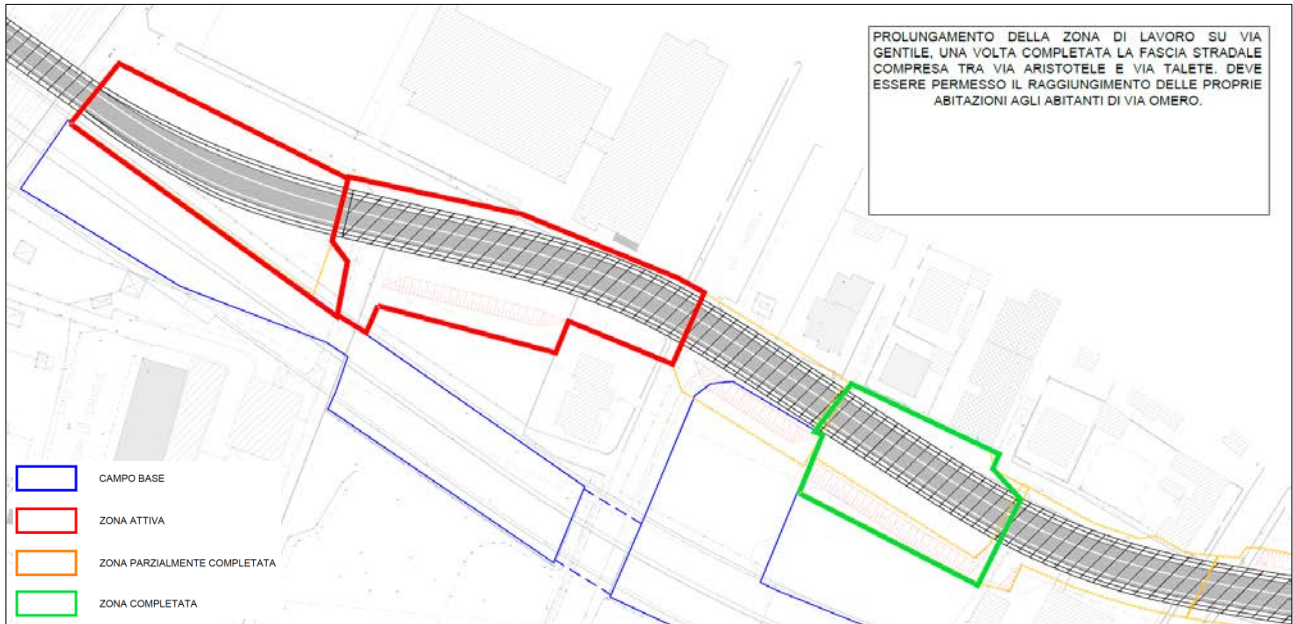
Fasi realizzazione copertura galleria del Piano di Sicurezza di progetto illustrativo della fase C di scavo della galleria
